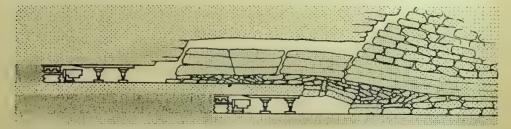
Strebbruchbau in 2 jeweils 1 m hohen Scheiben in einer Kaligrube
